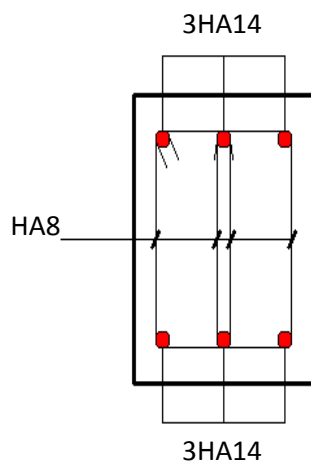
Représentation en plan des poutres secondaires non adhérees aux voiles au niveau de la structure.
